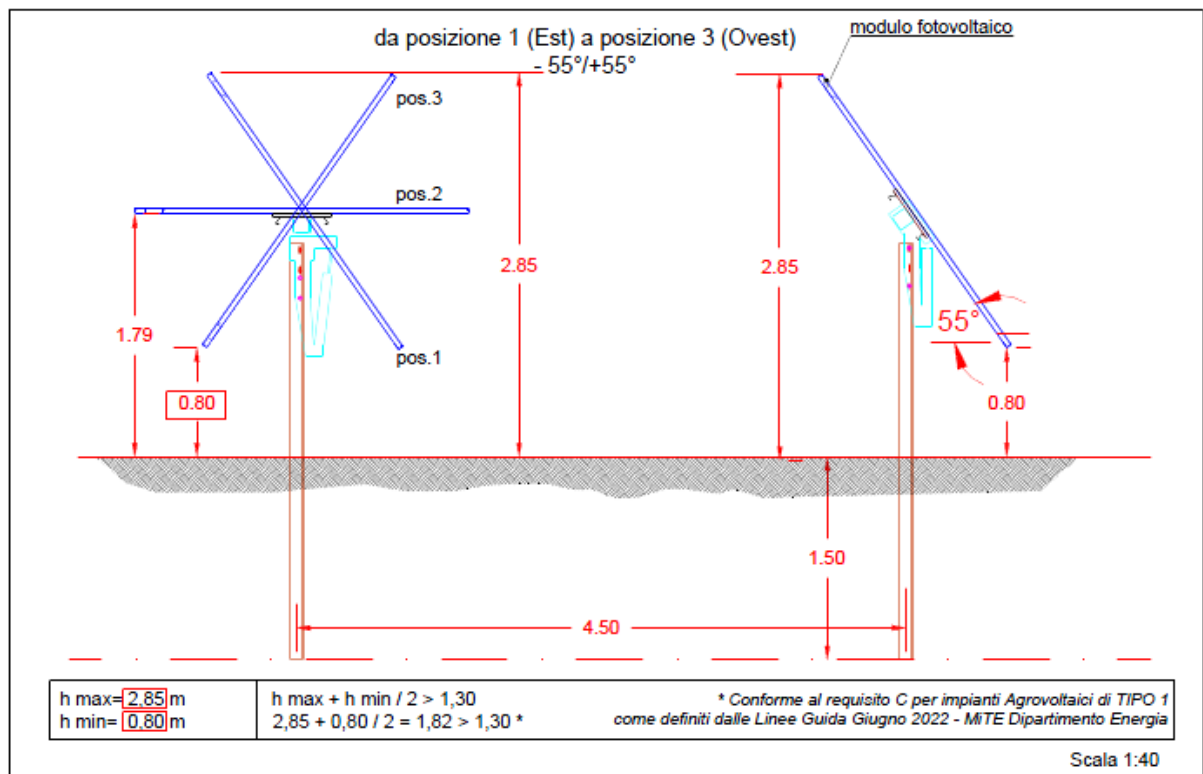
Nuova sezione strutturale con altezza minima a 80 cm
